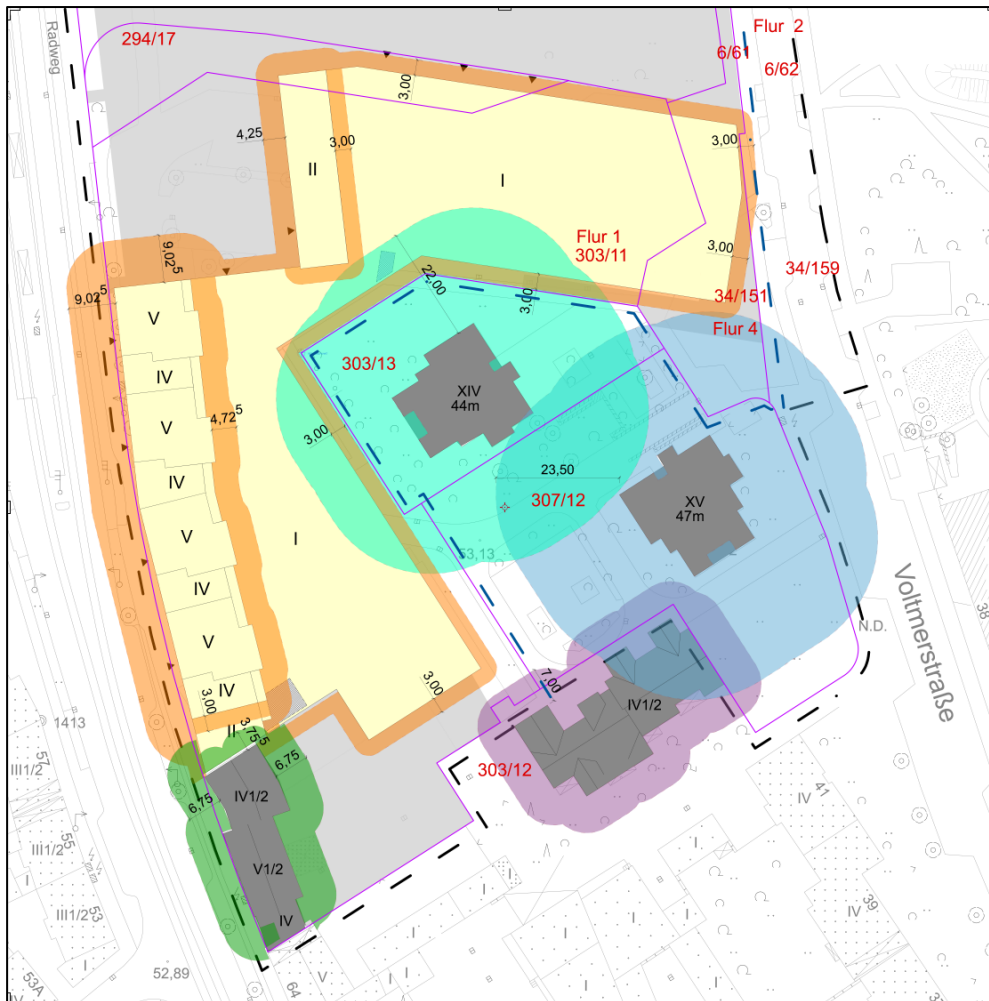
Abstandsflächen (generalPLAN GmbH 03.11.2015, unmaßstäbliche Darstellung)
